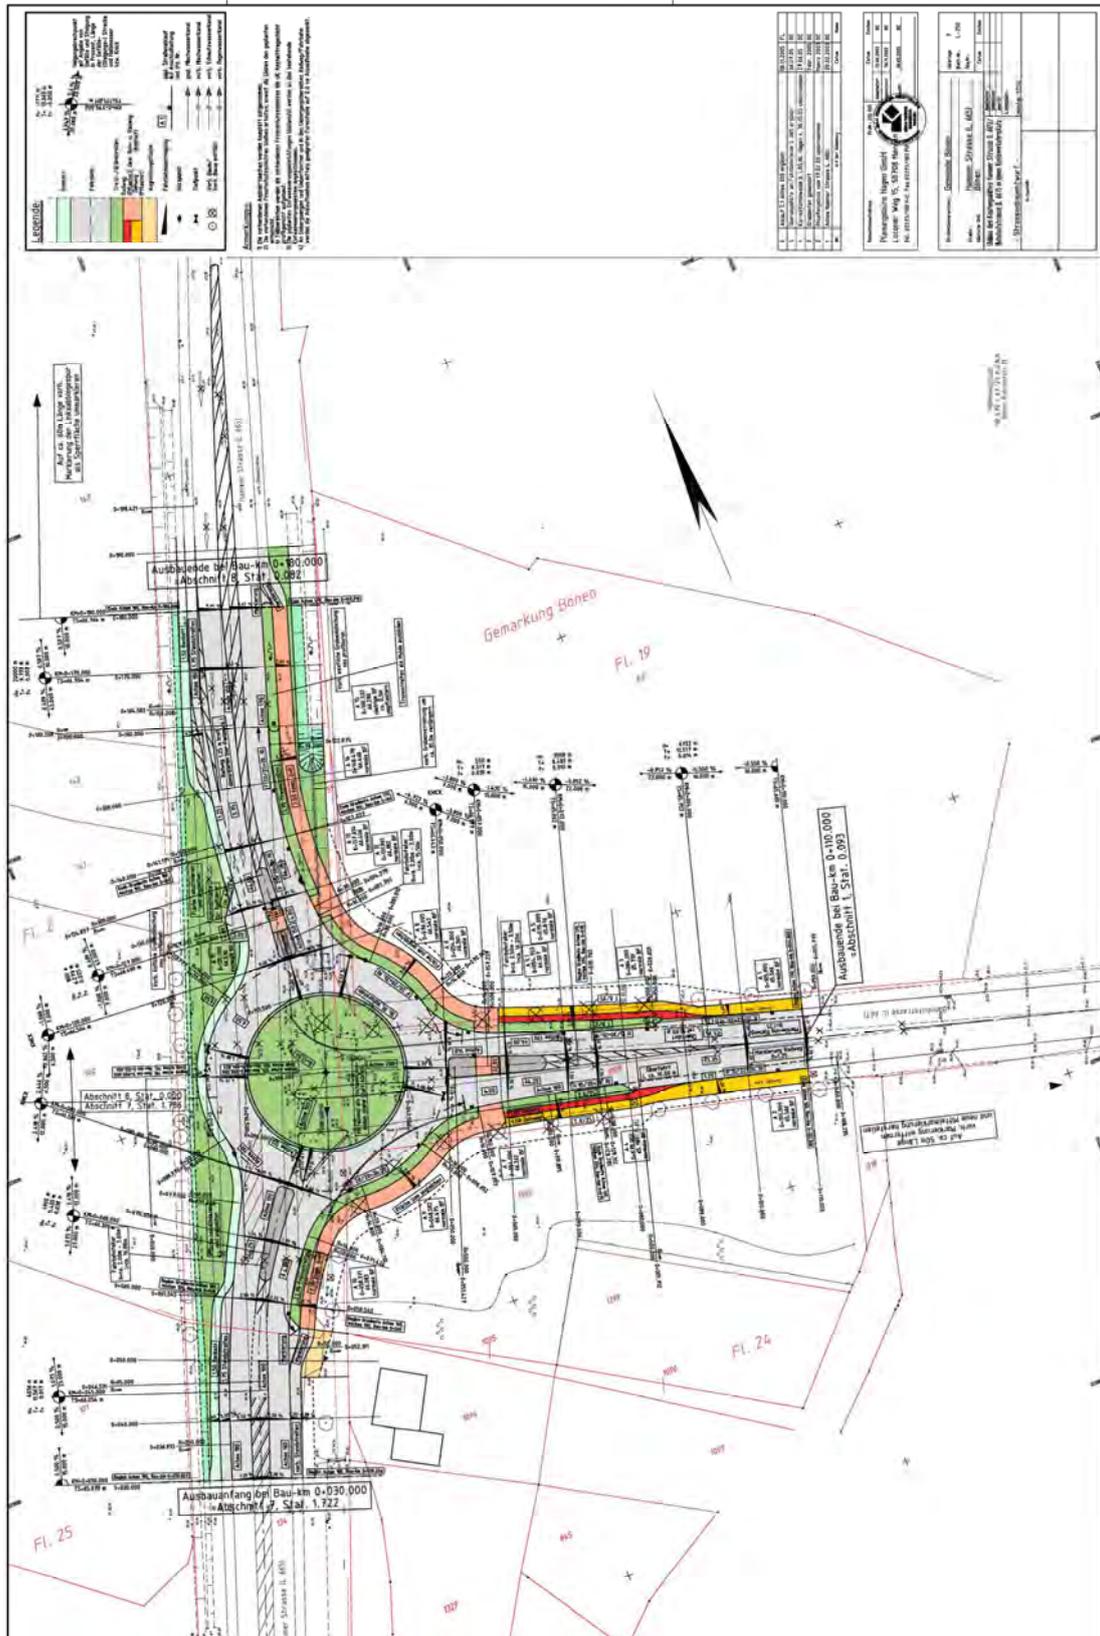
Planung Kreisverkehr Hammer Straße/ Bahnhofstraße
